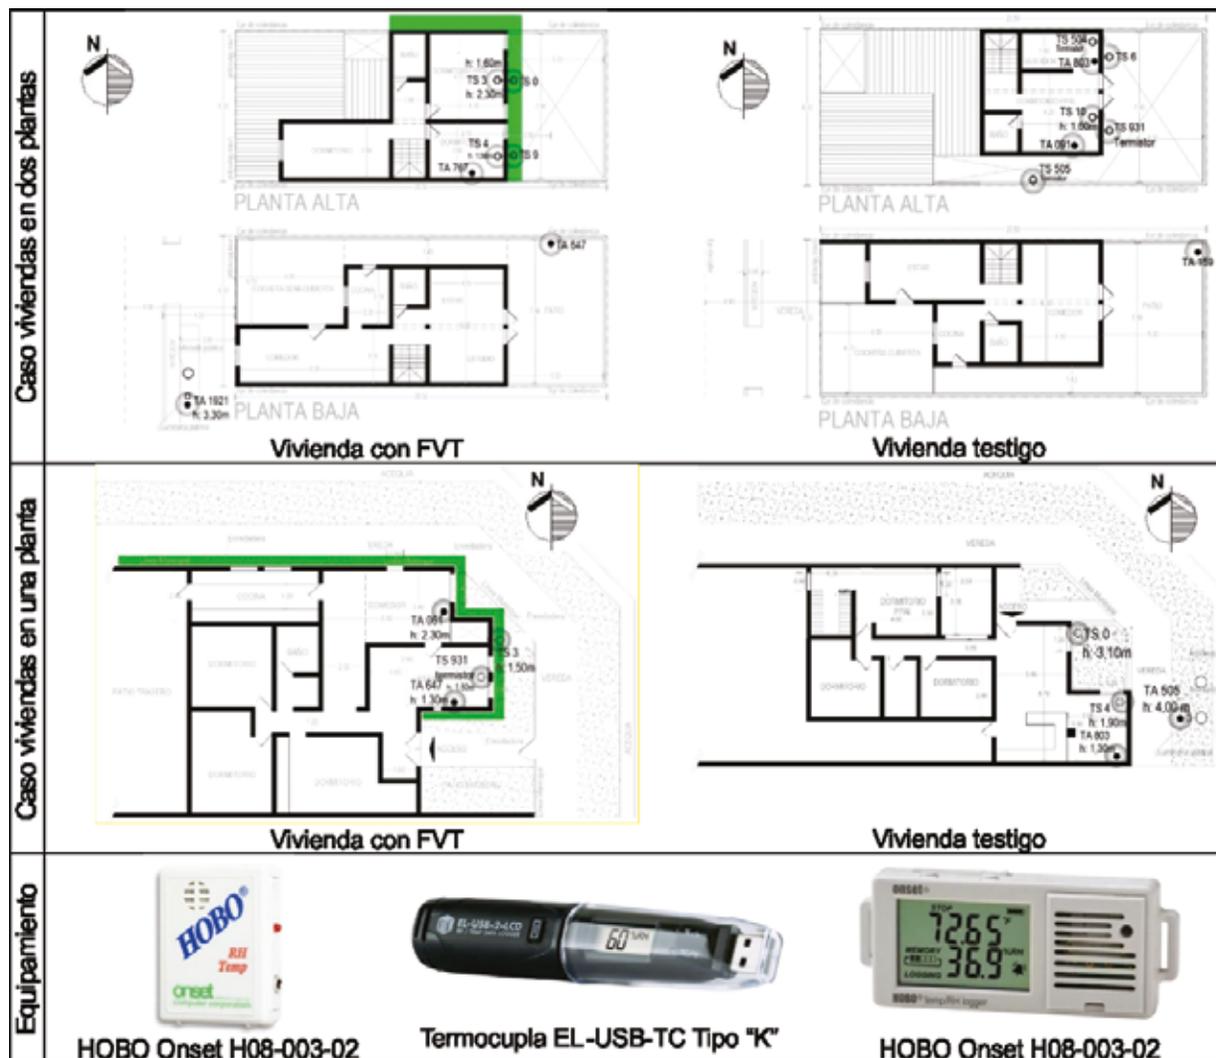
Plantas de las viviendas evaluadas con ubicación de sensores (color gris), y las FVT (color verde).
